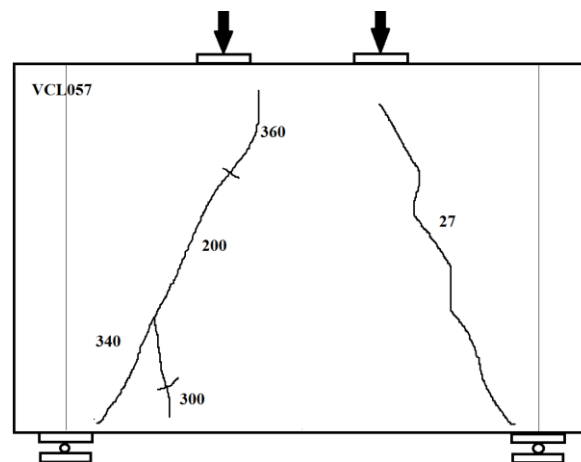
Esquema de fissuração da viga VCL057.
